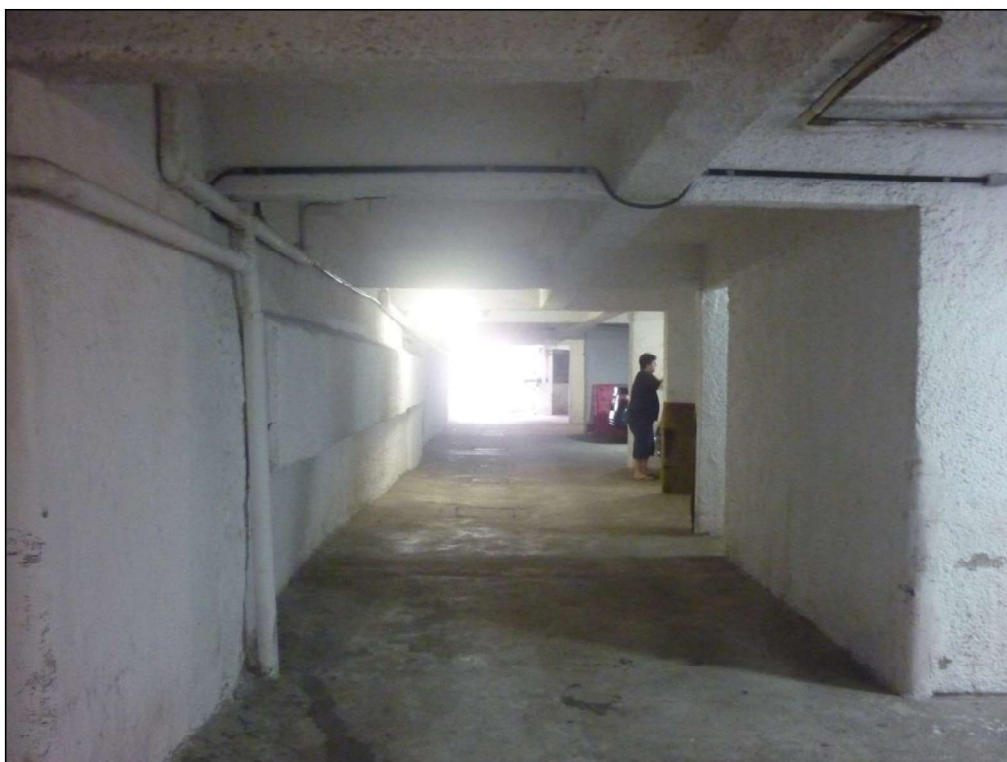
Outra vista do subsolo do Edifício Res Verde Mar.
